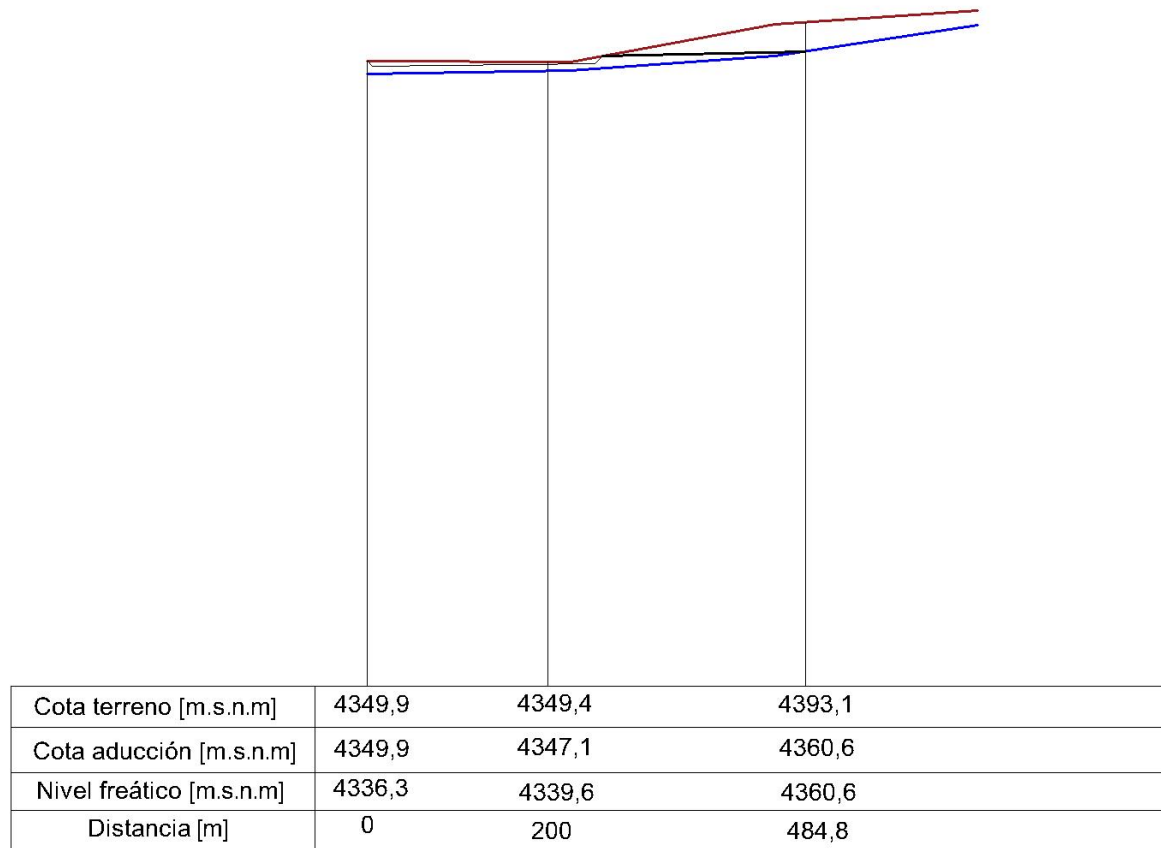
Perfil longitudinal de aducción en Quebrada 7.
